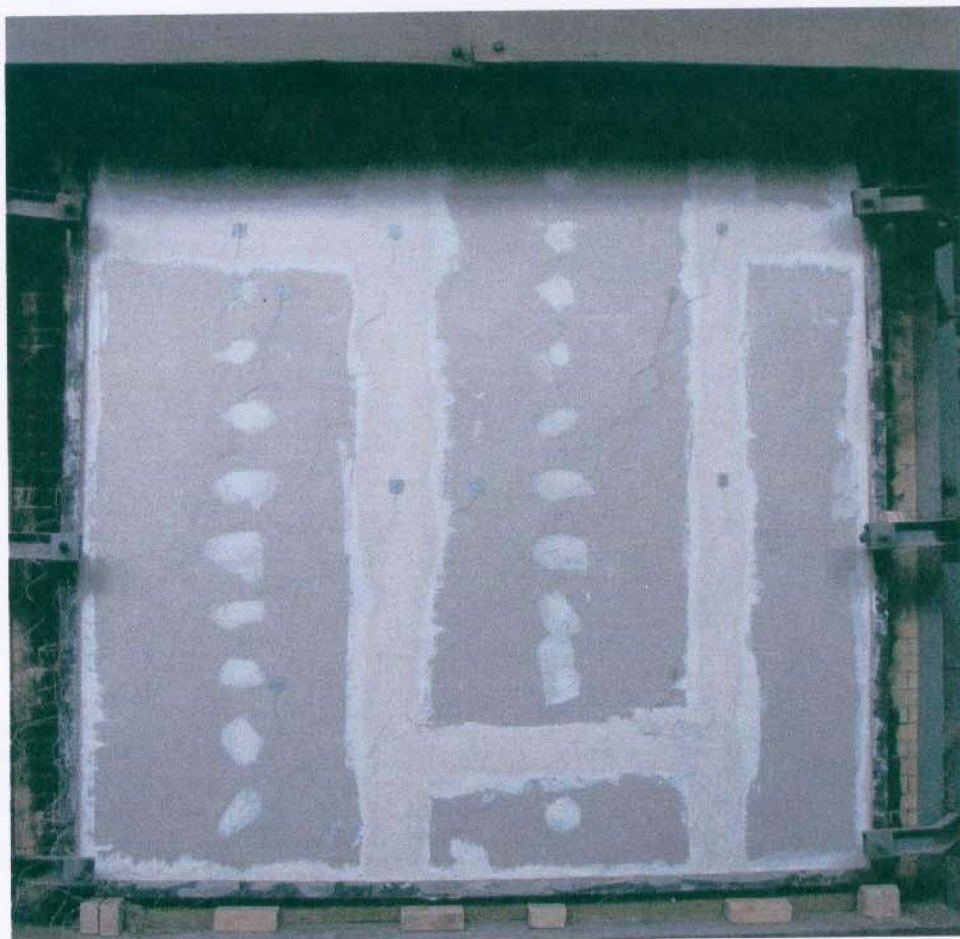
Образец № 1 перегородки типа С 132 до испытания
